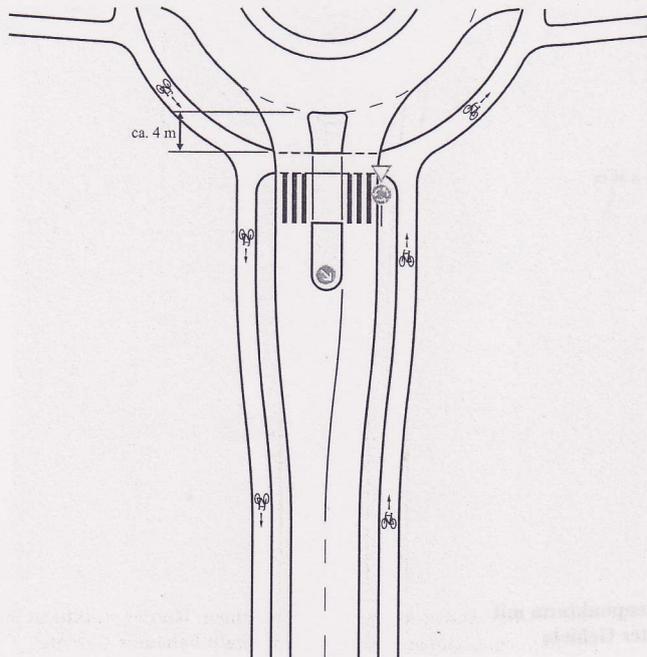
Beispiel der Radverkehrsführung in einem Knotenpunktarmp mit straßenbegleitenden Radwegen innerhalb bebauter Gebiete
